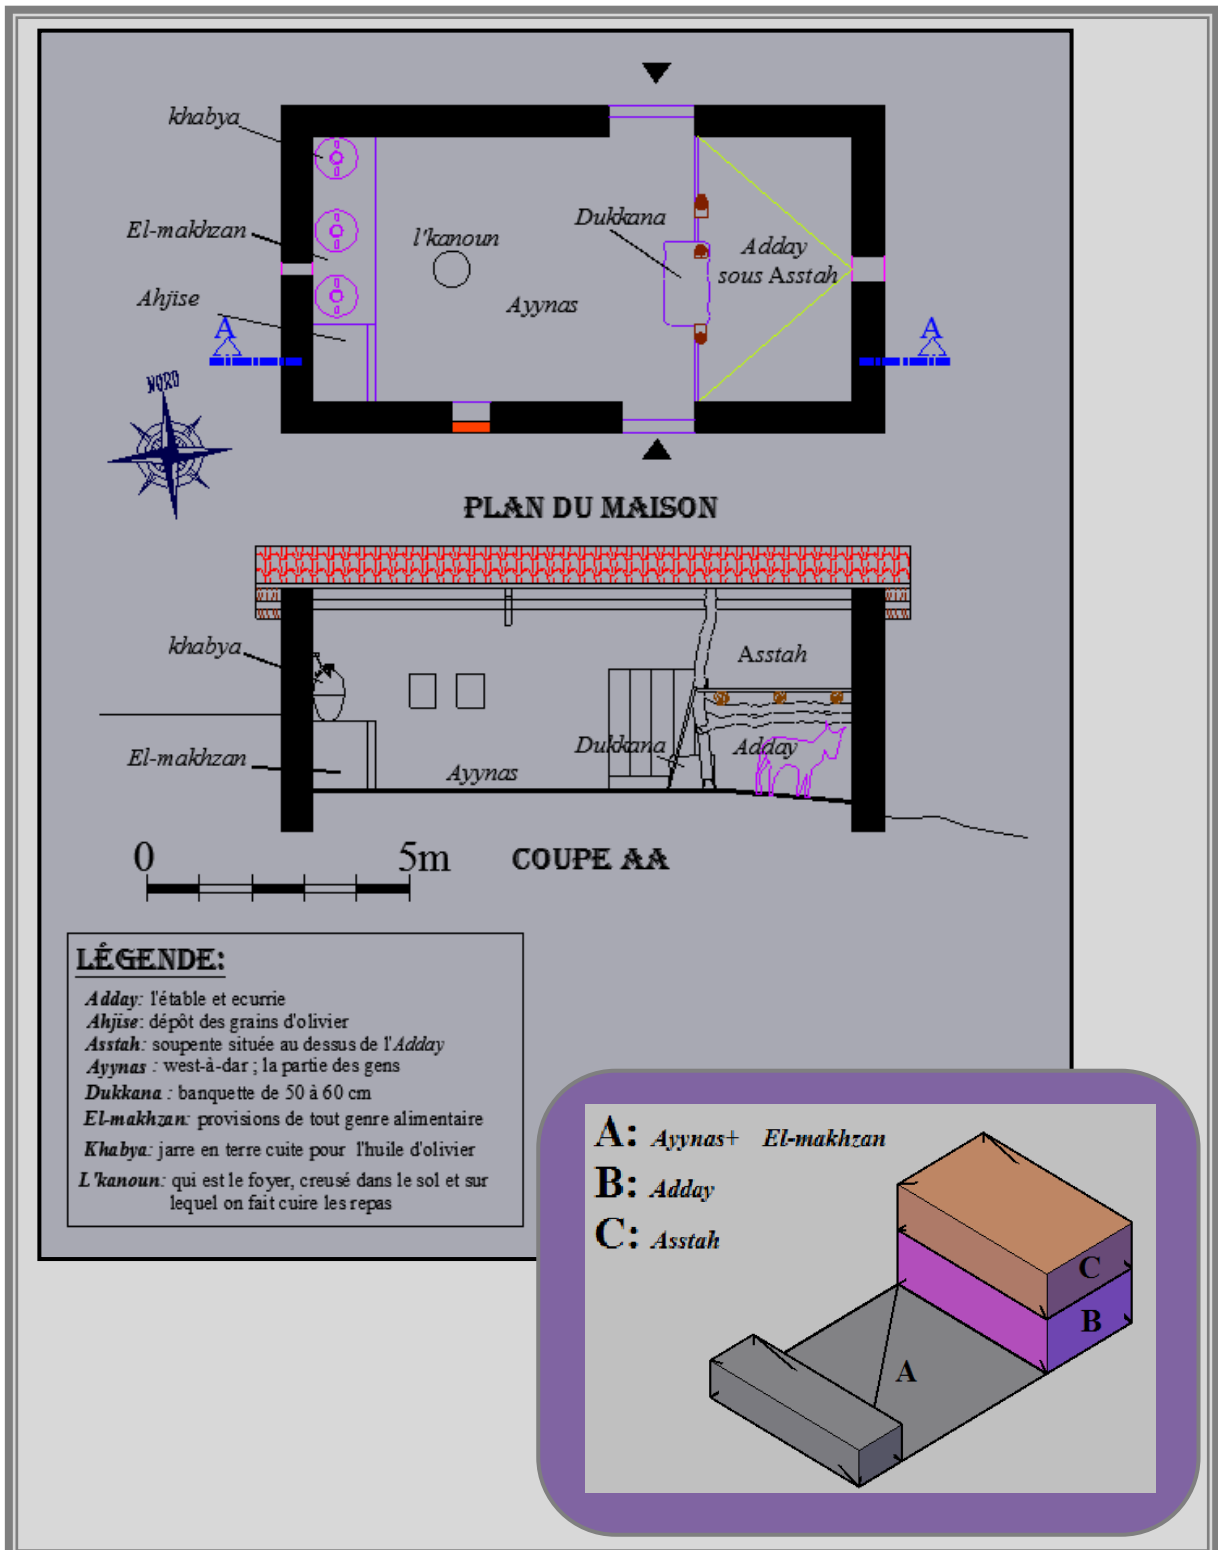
Plan et coupe longitudinale de la maison traditionnelle rurale.
